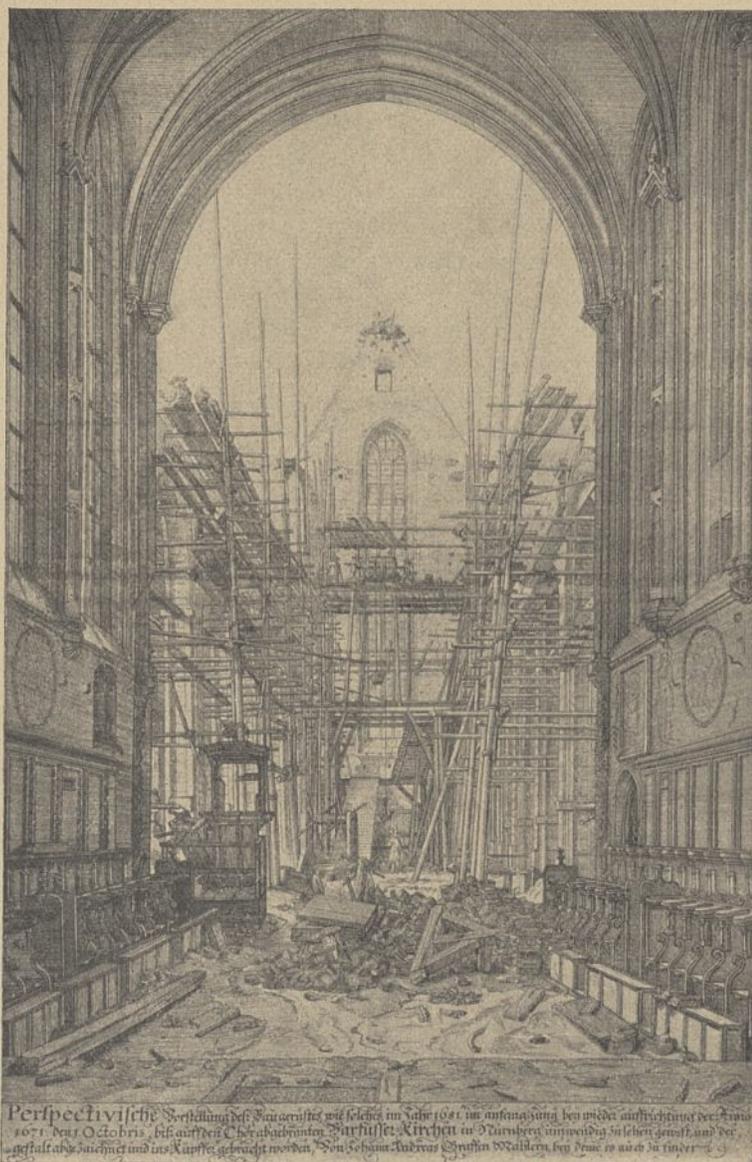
Ehemalige Barfüßerkirche, Baugerüst 1671.
